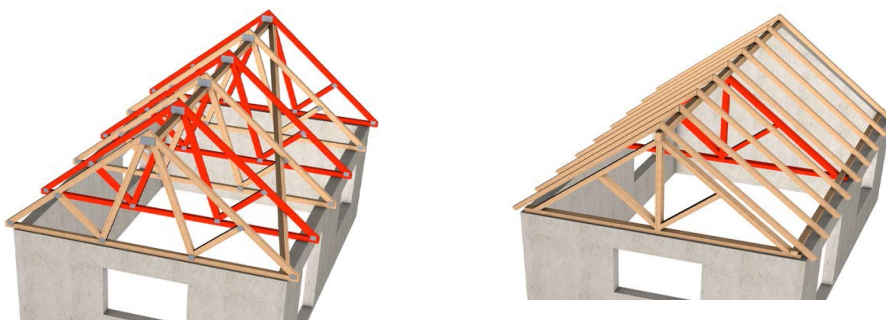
Exemple de renforcement de charpente traditionnelle ou en fermette en bois
